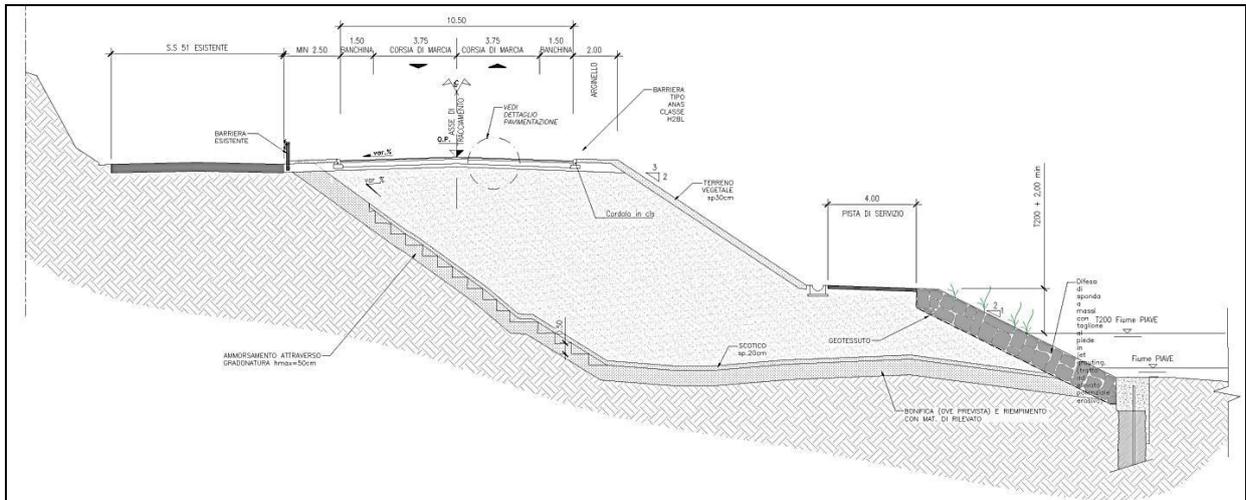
Sezione tipo C1 in affiancamento alla SS51 esistente.
